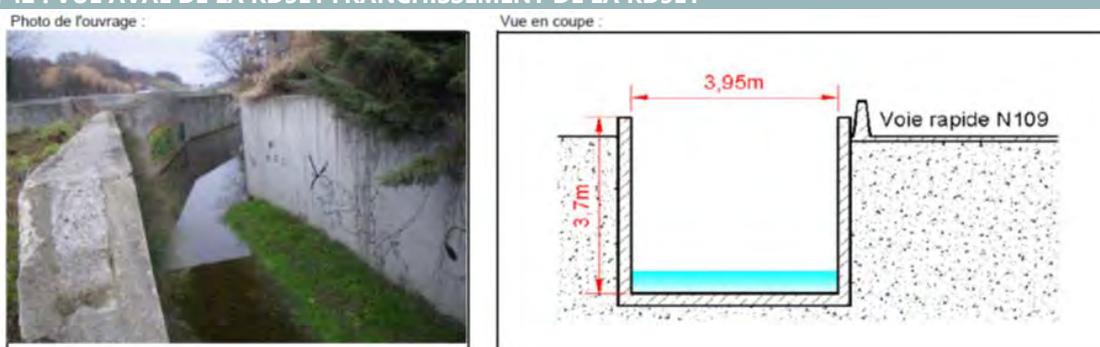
OUVRAGE ET COUPE DE L'OUVRAGE DE FRANCHISSEMENT DE LA RD5E1
